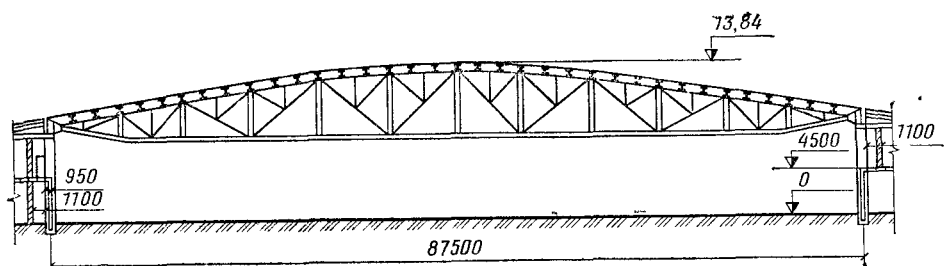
Балочная конструкция покрытия ангара. Поперечный разрез
